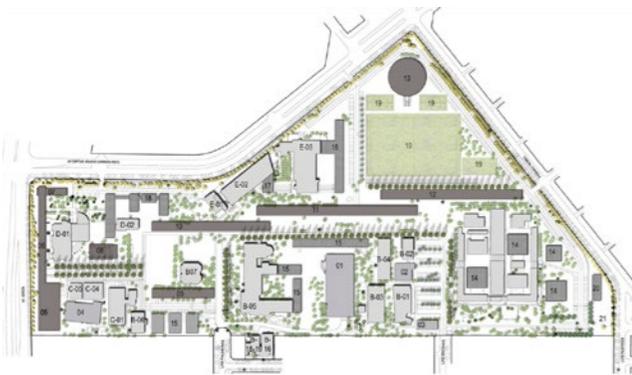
Planta general Plan Maestro JGM Fuente: Gubbins Arquitectos
